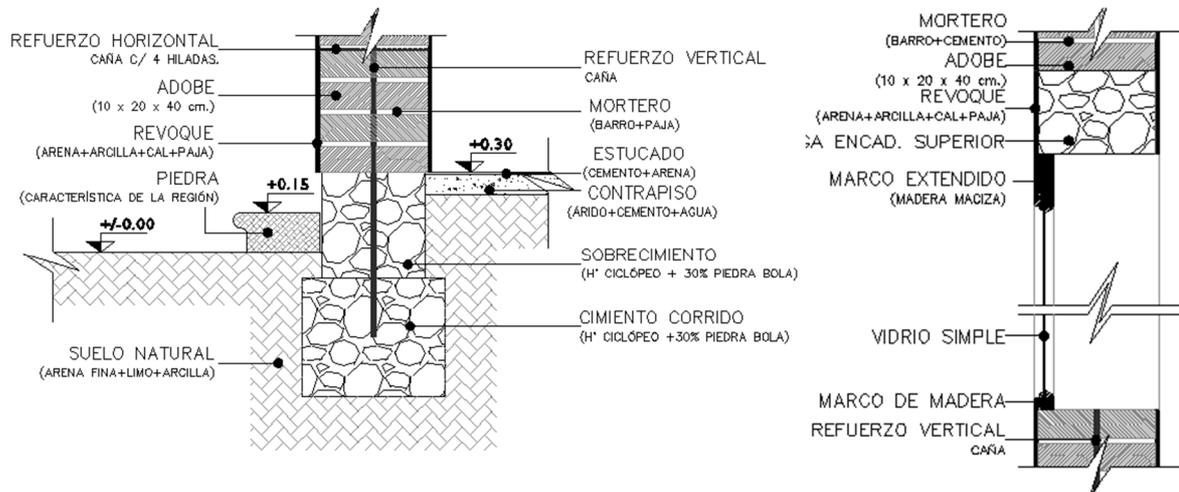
Detalles del sistema constructivo para muros en adobe y caña: cemento, sobrecimiento, viga de encadenado superior y carpintería.
